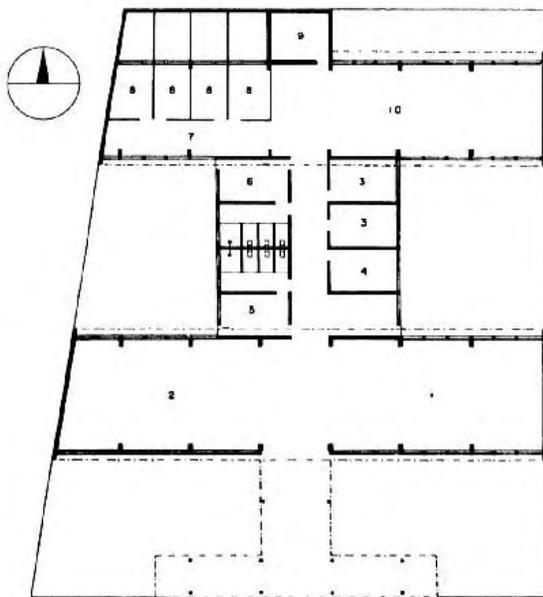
e 43: Planta baixa e vista dos Ateliers.
